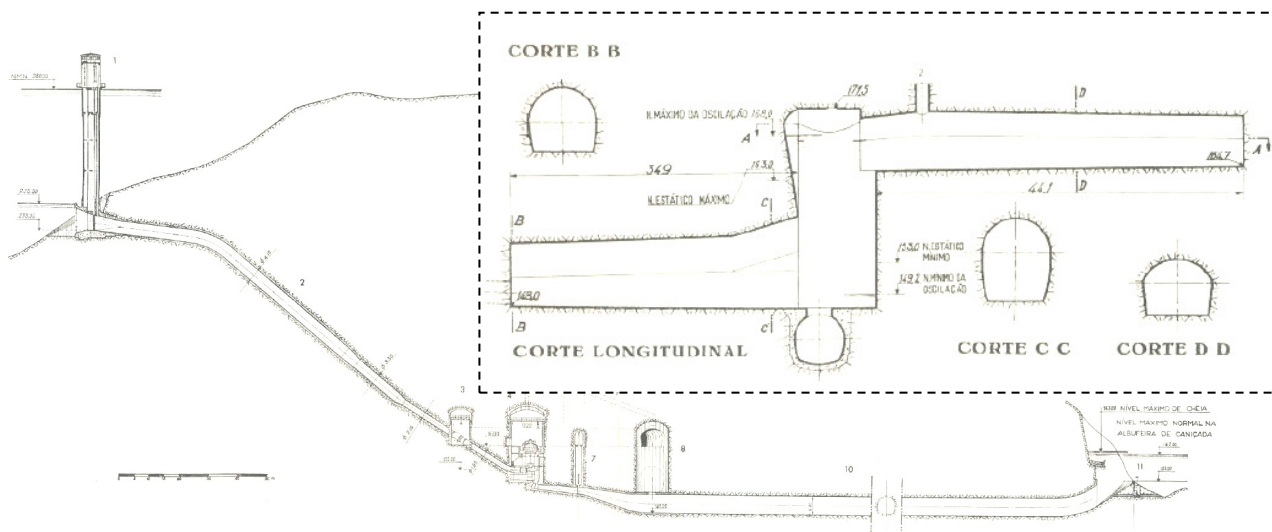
Perfil longitudinal e CE do AH de Salamonde, [6].
